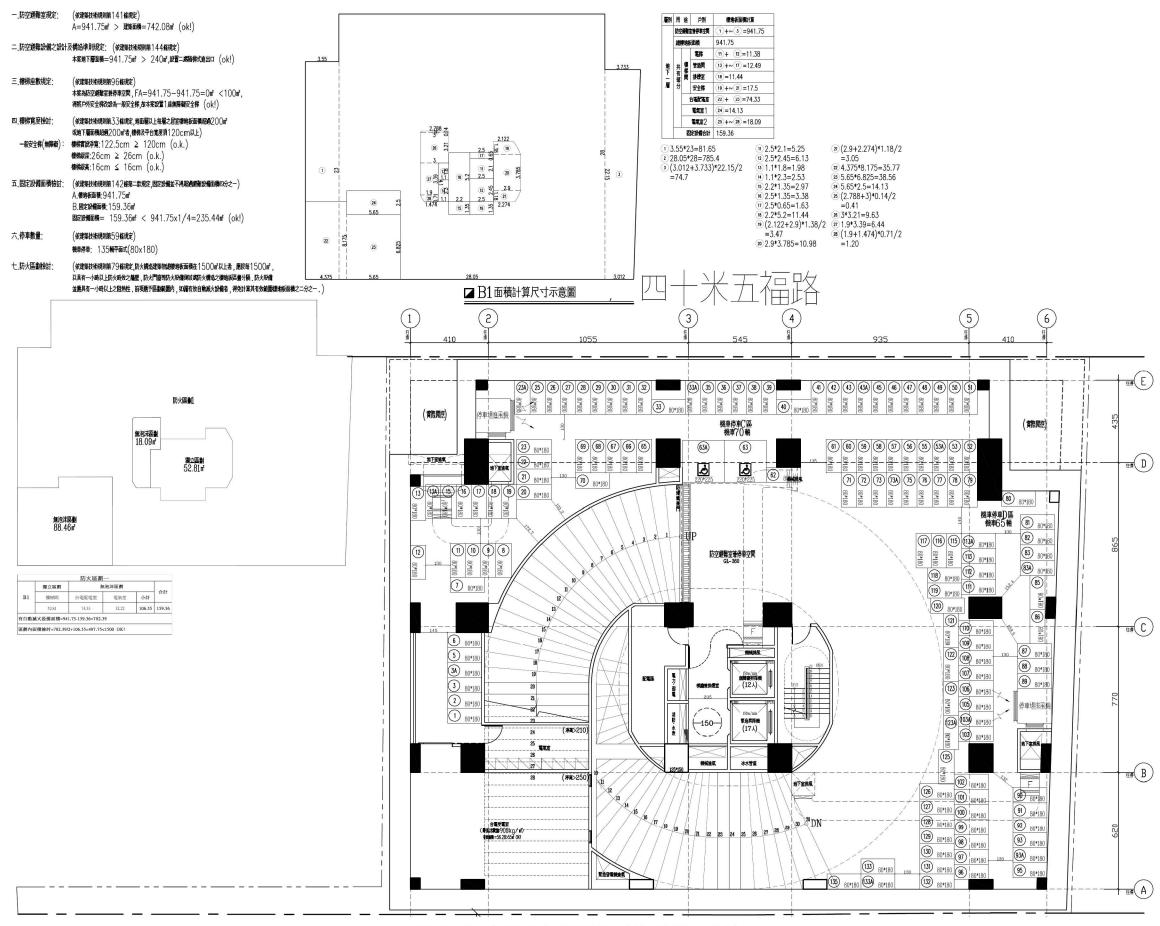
地下 1 層平面圖 (比例尺 1/200)
